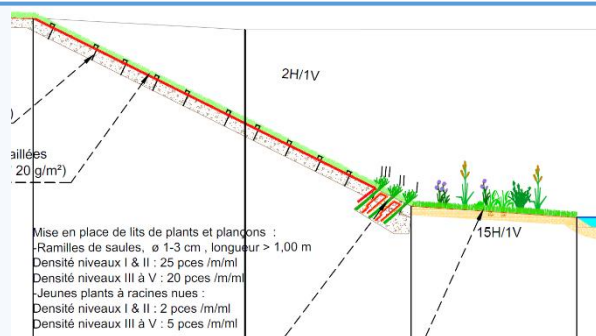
Lits de plants & plançons sur une coupe - AKERS
